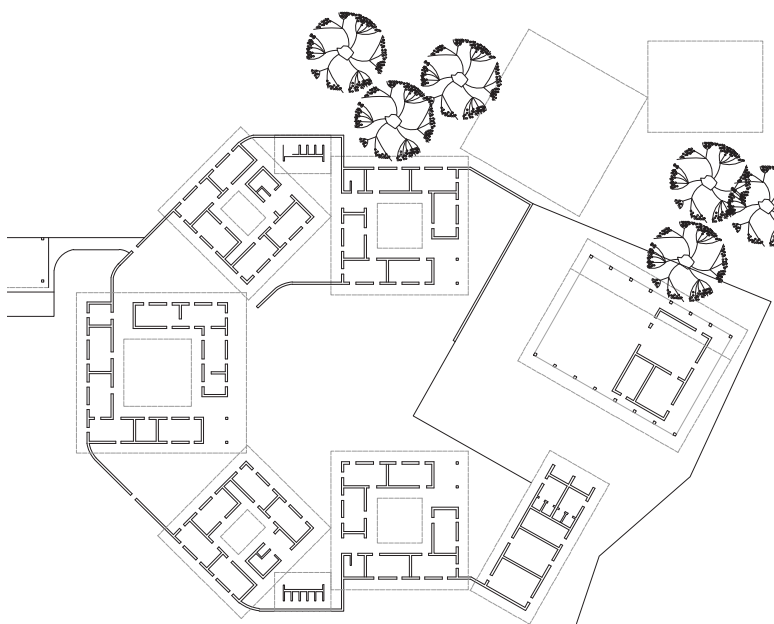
Planta Orfanato Noomdo. Escala 1:1000
